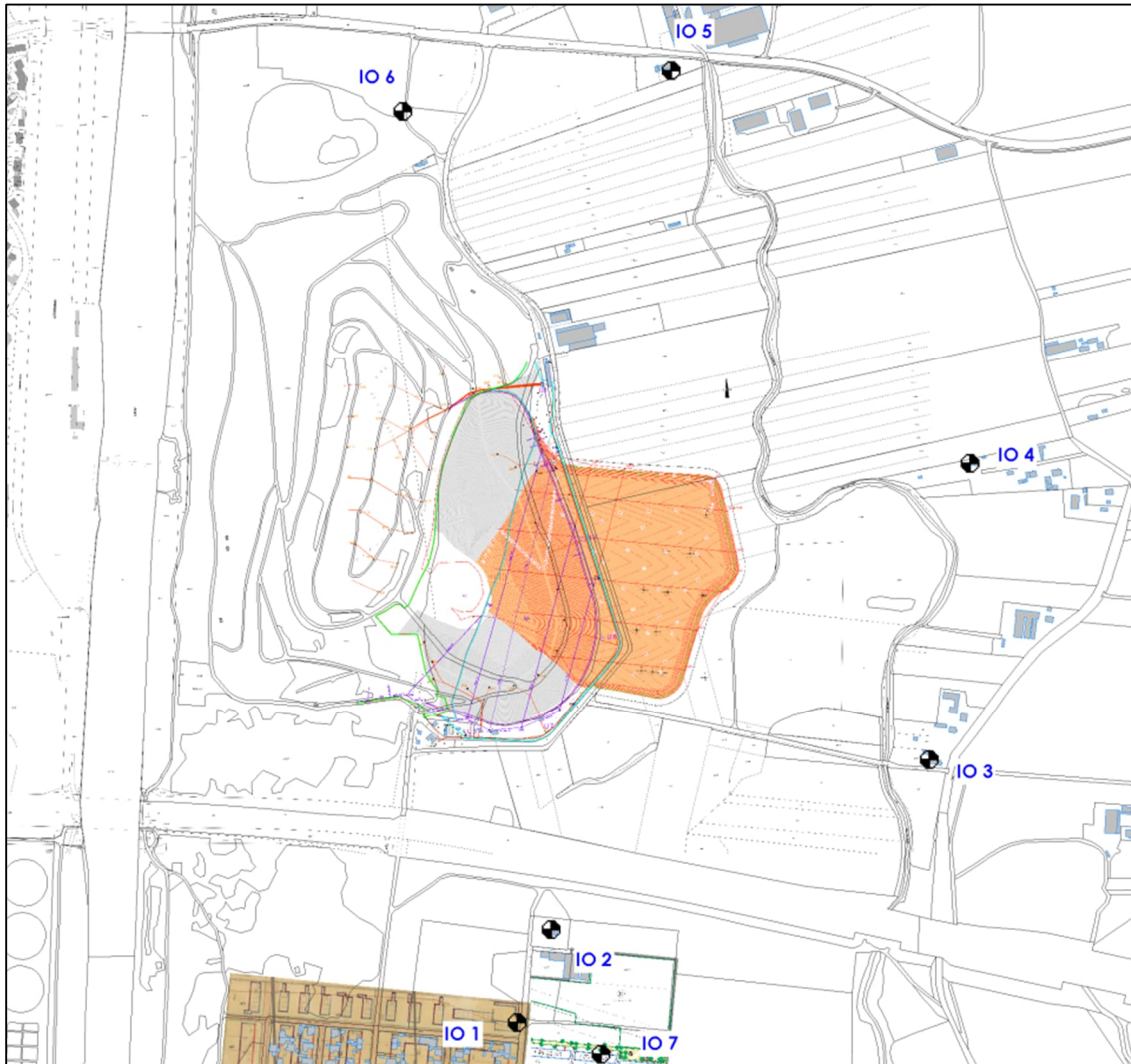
Lageplan /10, 23, 24, 33/ mit Darstellung der Immissionsorte (IO)
